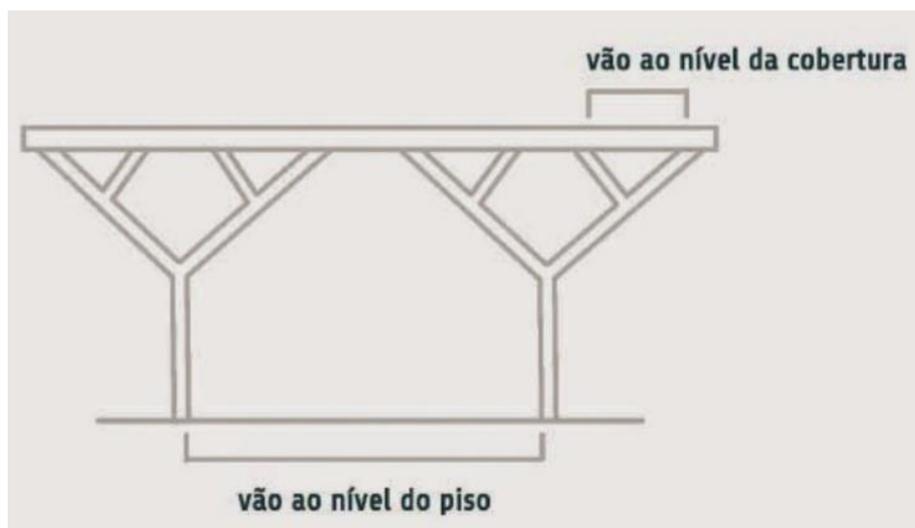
Concepção: Estrutura de uma Cobertura Arbórea
